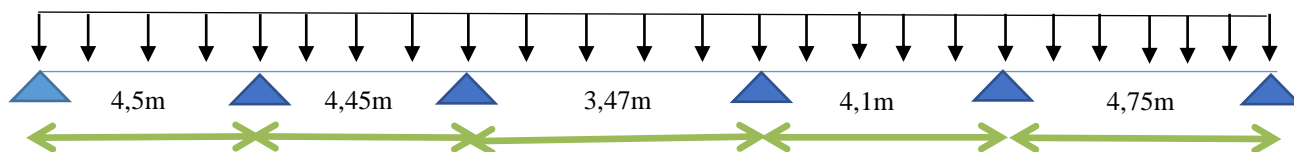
Schéma statique de la Poutrelle à six travées.
